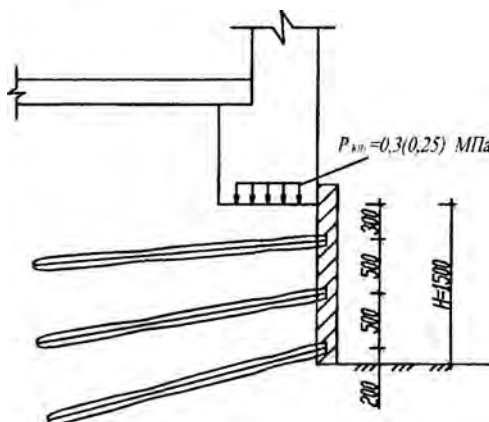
Расчетная схема для определения устойчивости подпорной стенки
